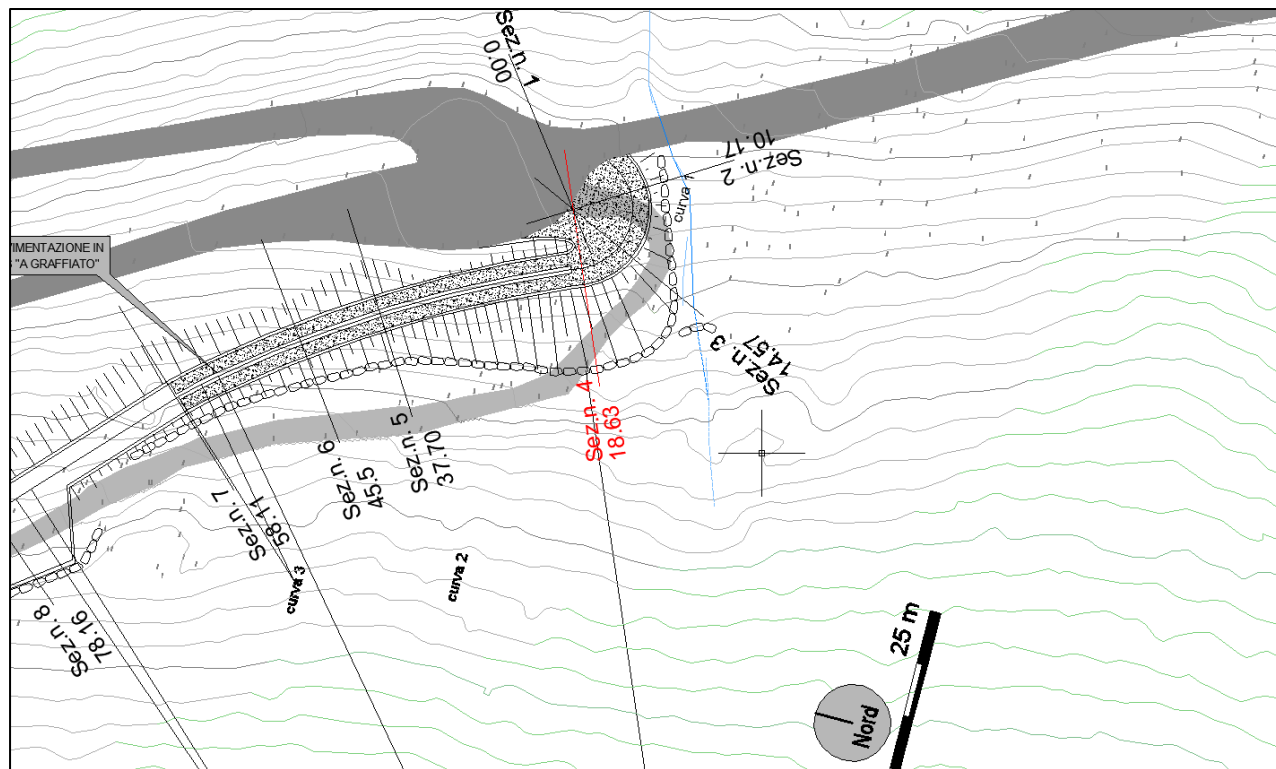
Loc. Indervrotn - SEZ. 4 - UBICAZIONE TRACCIA SEZIONE DI CALCOLO GEOTECNICO
